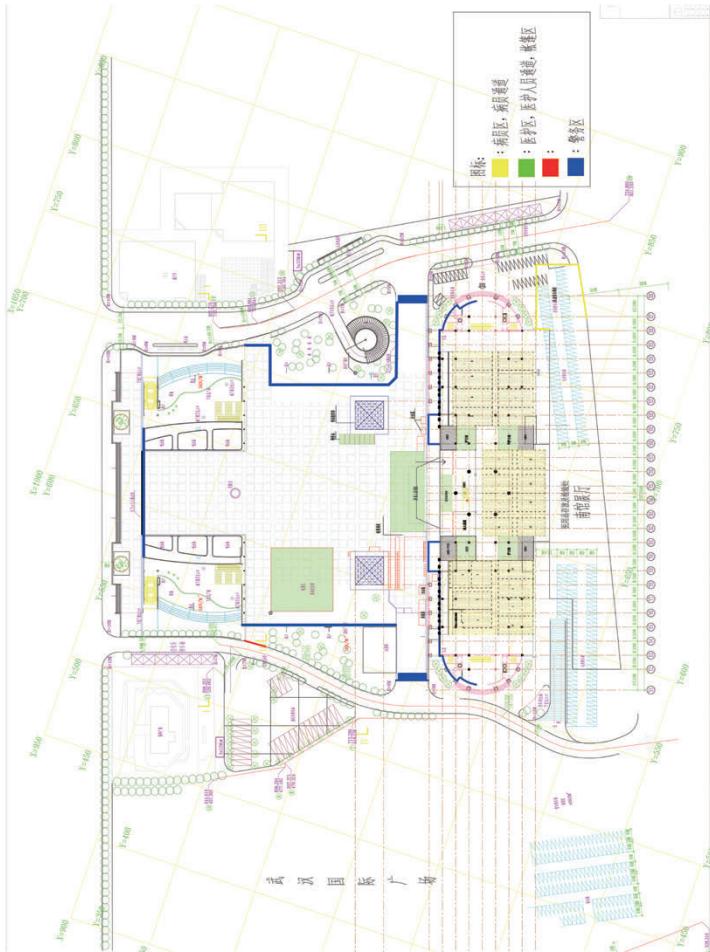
卓尔（江汉武展）方舱医院一楼平面图
